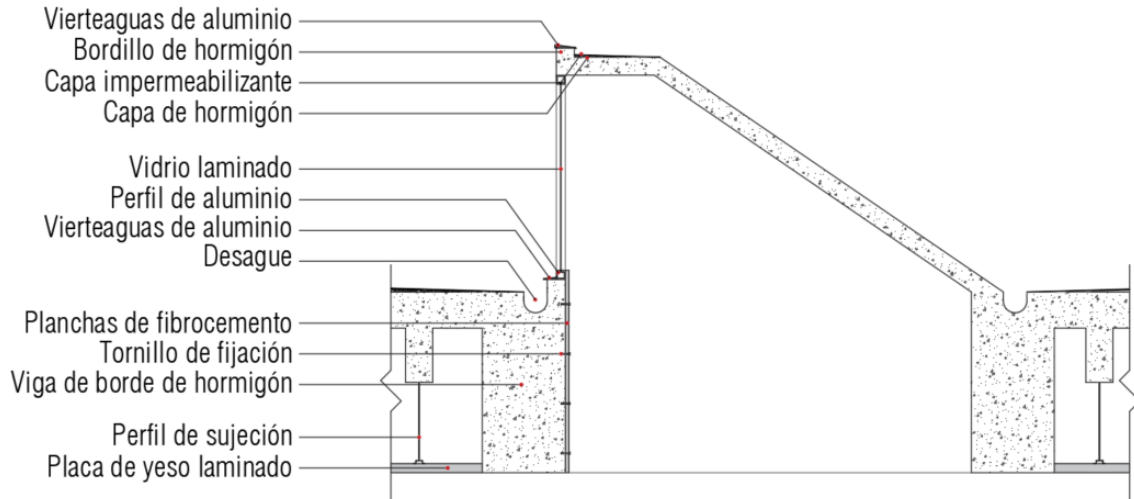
Detalle A2 - Proyecto definitivo. Elaboración propia.
